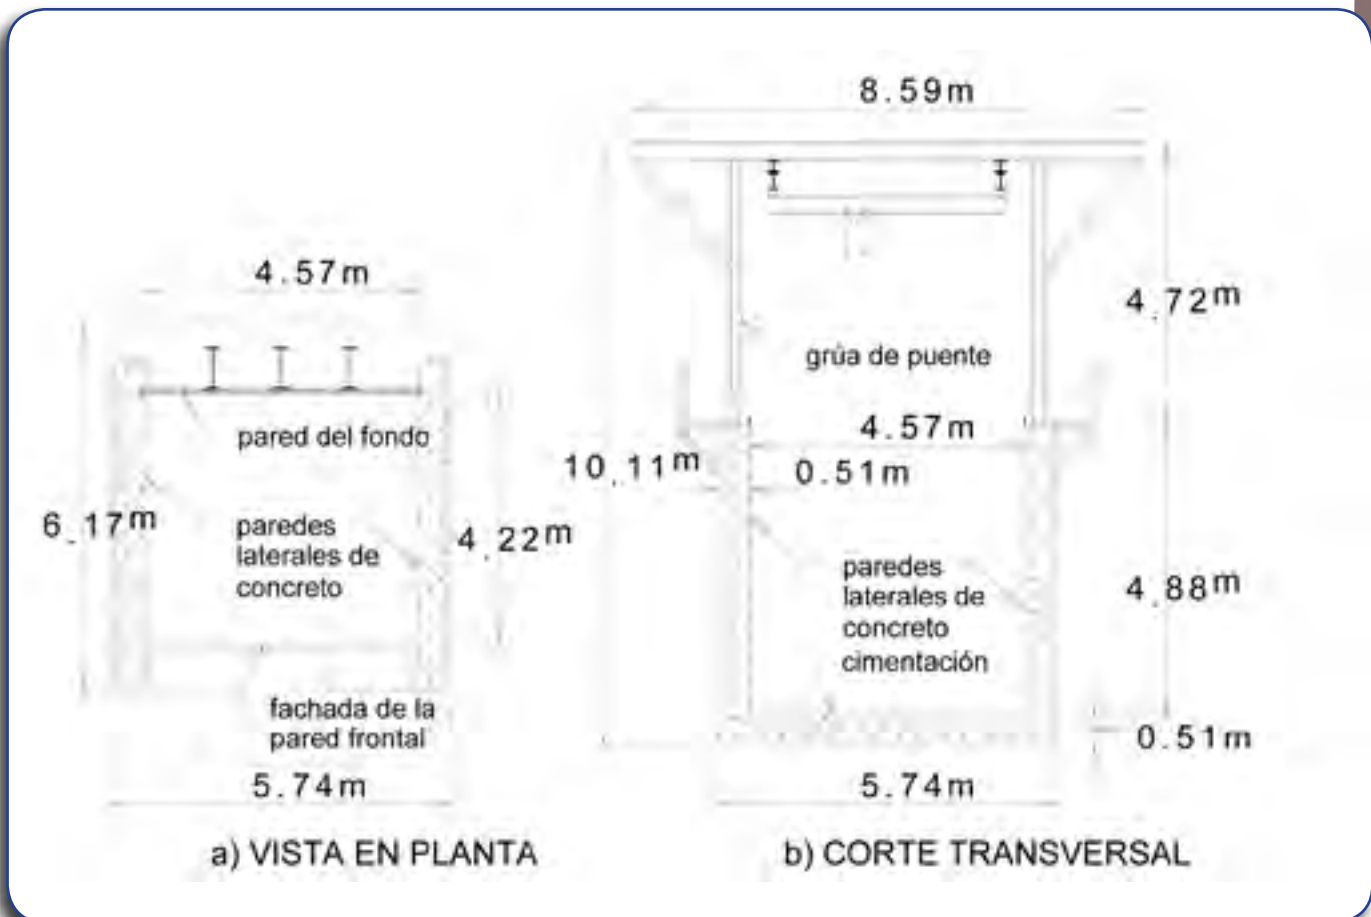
Planta y corte transversal de un muro de contención de tamaño natural
